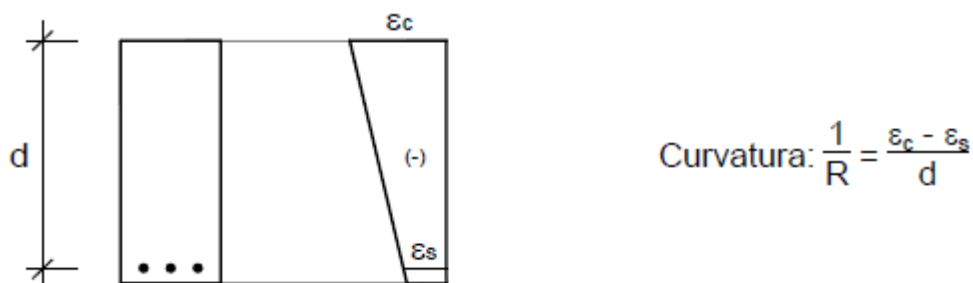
Viga não fendilhada só com armadura inferior (Fonte: (Camara 2014))
